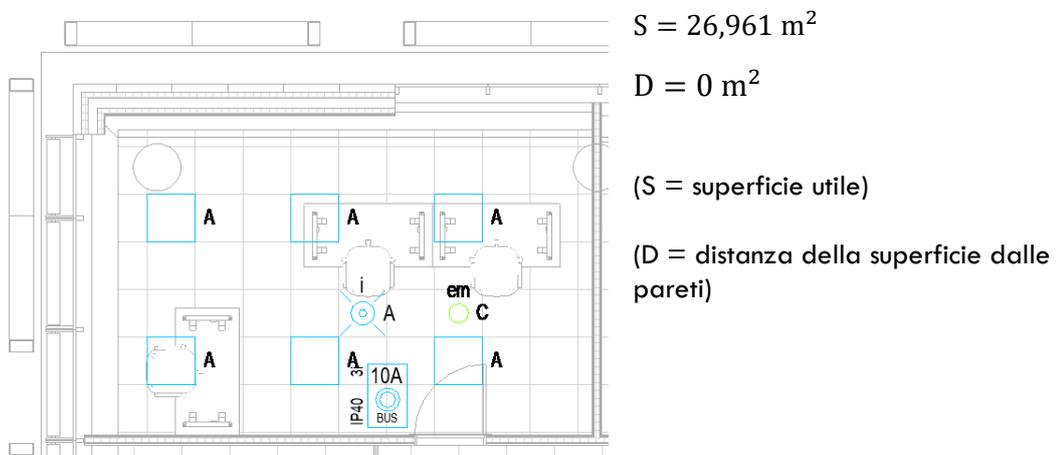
Vista in pianta dell'ufficio tipo scelto per il calcolo illuminotecnico
